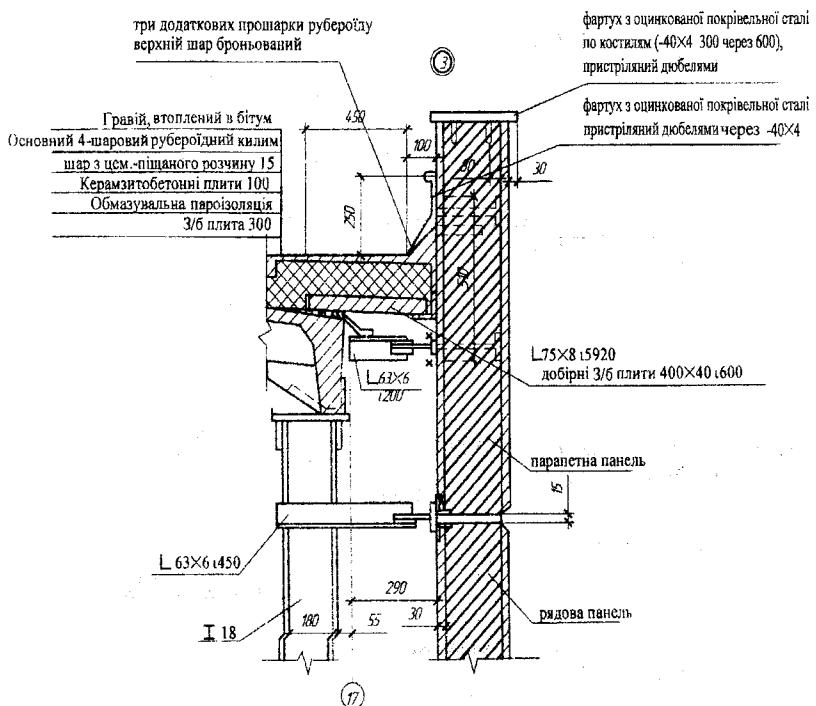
Парапетний вузол одноповерхової будівлі
